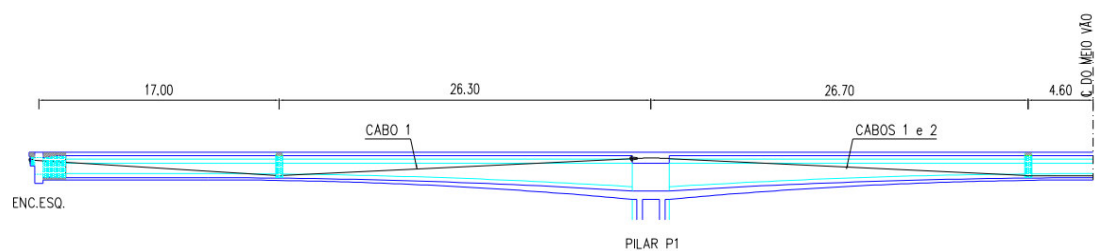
Perfil longitudinal do traçado dos cabos de pré-esforço
